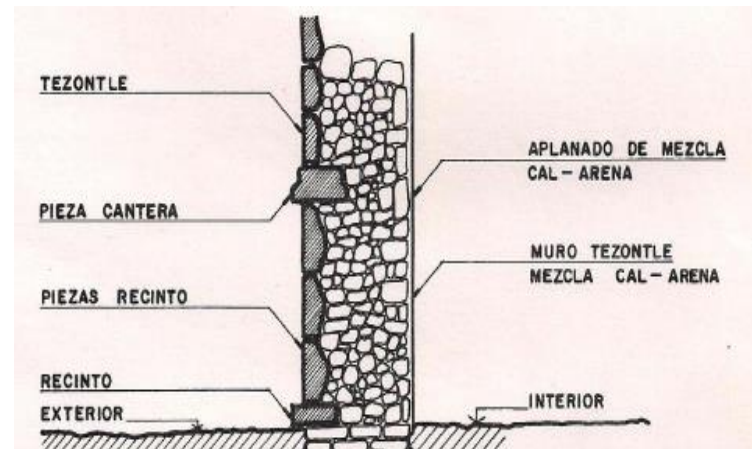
Detalle en mamposteo de piedra donde se aplica el aplanado de cal-arena.
